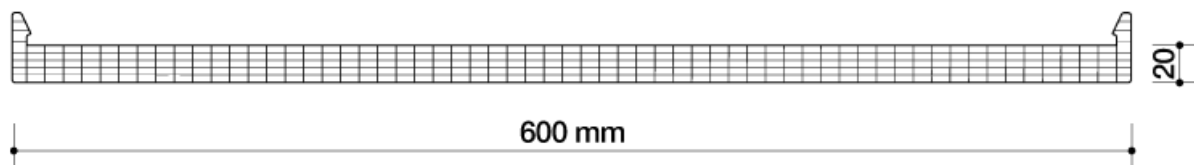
Dibujo en planta de una placa para sistemas modulares con conectores. En la ilustración se aprecian las dimensiones y la forma de las pestañas que facilitan el encastre. En esta imagen se muestra la placa arcoPlus Reverso626® de la empresa dot.gallina. [Extraída de: <http://www.simet2.it/policarbonato/coperture-reverso>]
